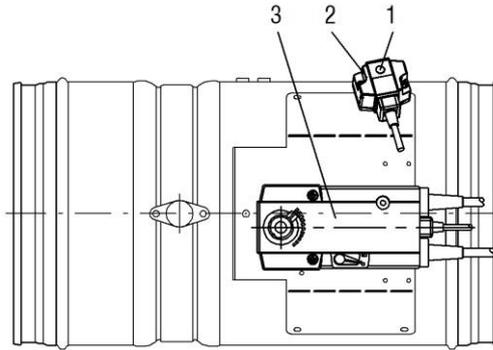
Seitenansicht BSK-RPR (Federrücklaufantrieb B10/B11)
